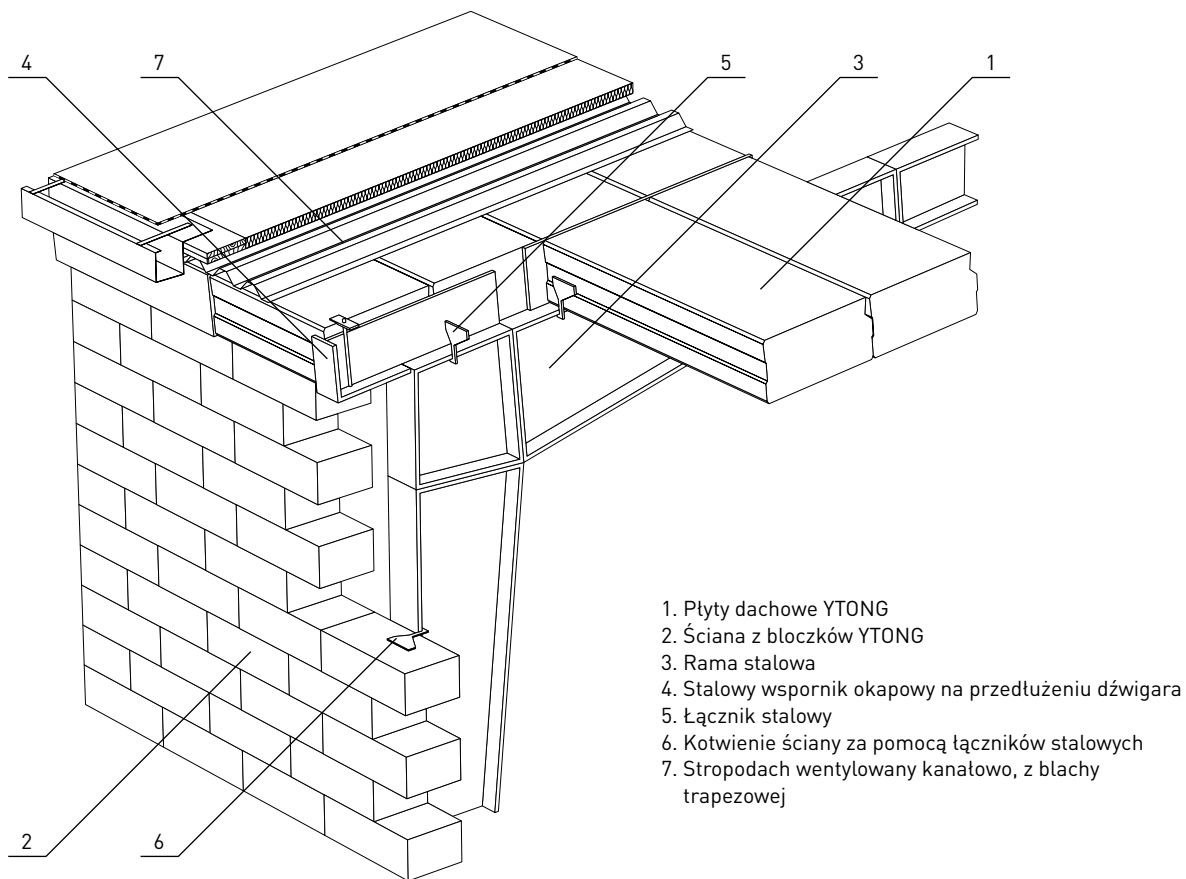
Stropodach budynku halowego o konstrukcji żelbetowej z obudową z płyt dachowych i bloczków ściennych YTONG.
